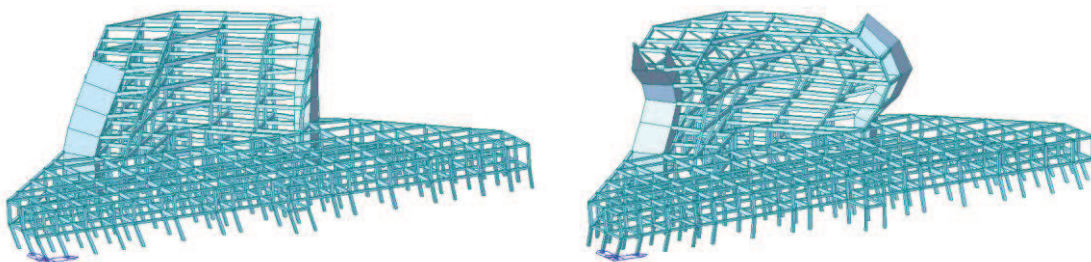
Modi di vibrare 6-7 struttura a base fissa
